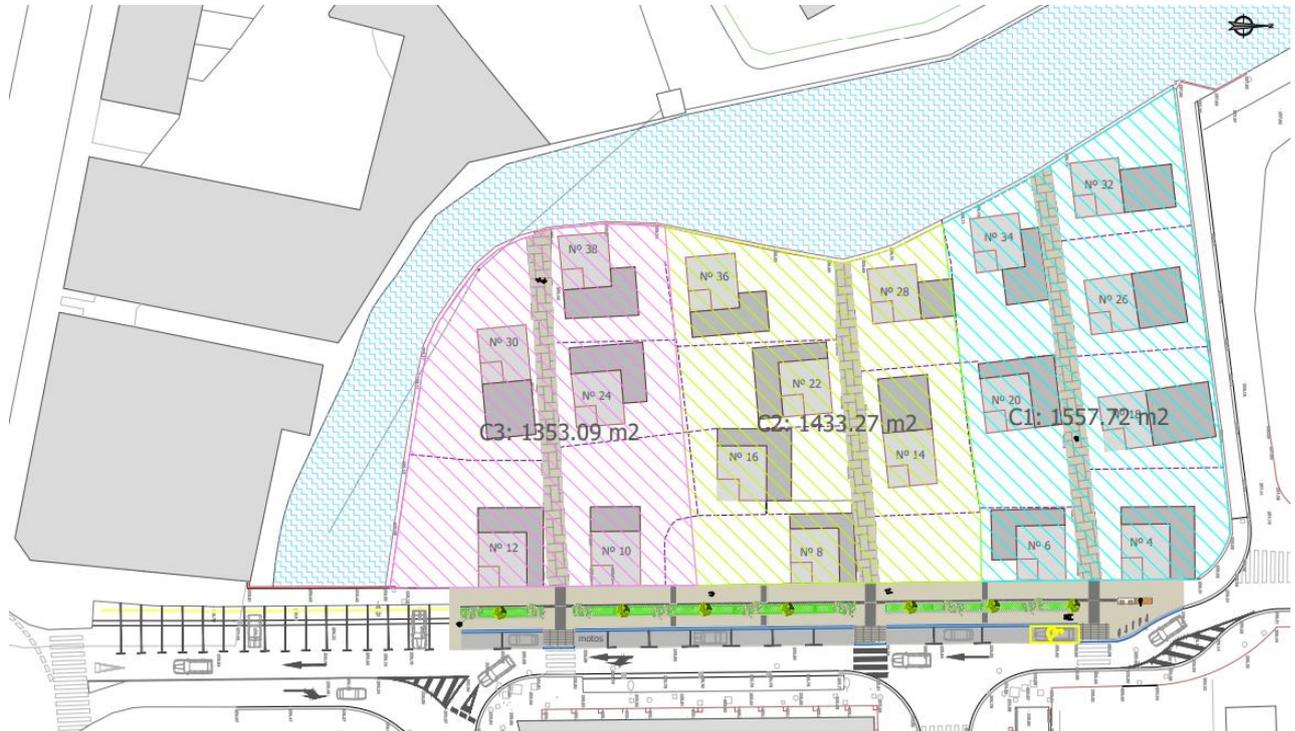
Planta cuencas área "54 Etxe Txikiak"
